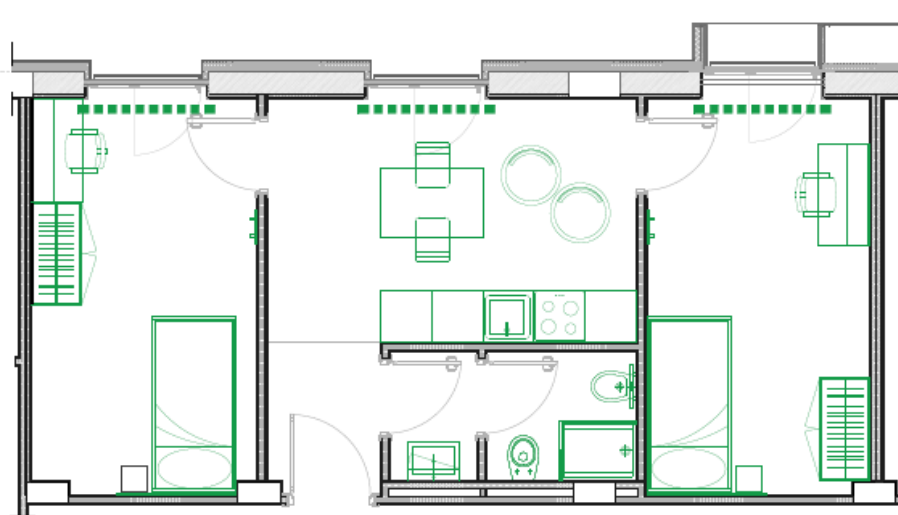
Pianta tipologia Antares - Fonte: archivio In-Domus
